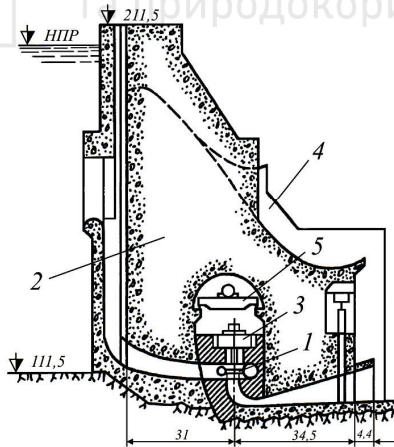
Поперечний переріз вбудовано-водозливної будівлі ГЕС:
